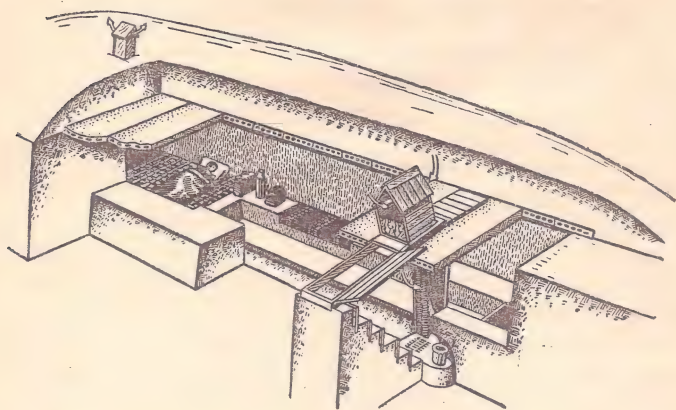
Укрытие без одежды крутостей с перекрытием из железобетонных плит (ослабляет действие радиации в 300—400 раз; ширина площади опоры плит на бровку откоса не менее 50—80 см)
